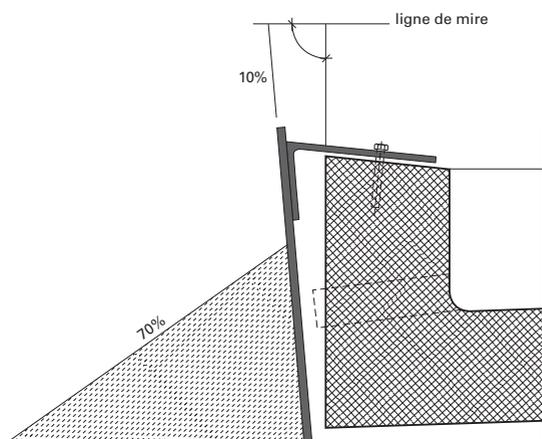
Cible avec plaque blindée renforcée réglementaire (montage en rive de toiture en cas de toiture enroulable)
